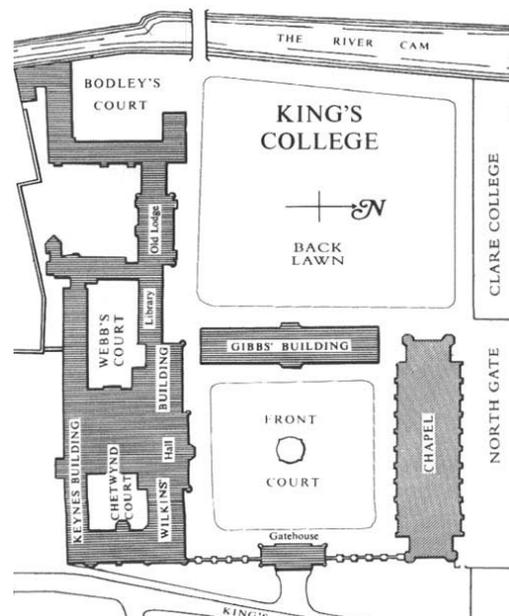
15: King's College, Plan im 20. Jahrhundert
